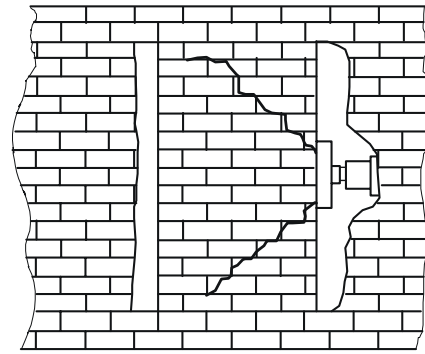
Prueba de corte en el sitio sobre una porción de un muro de mampostería
